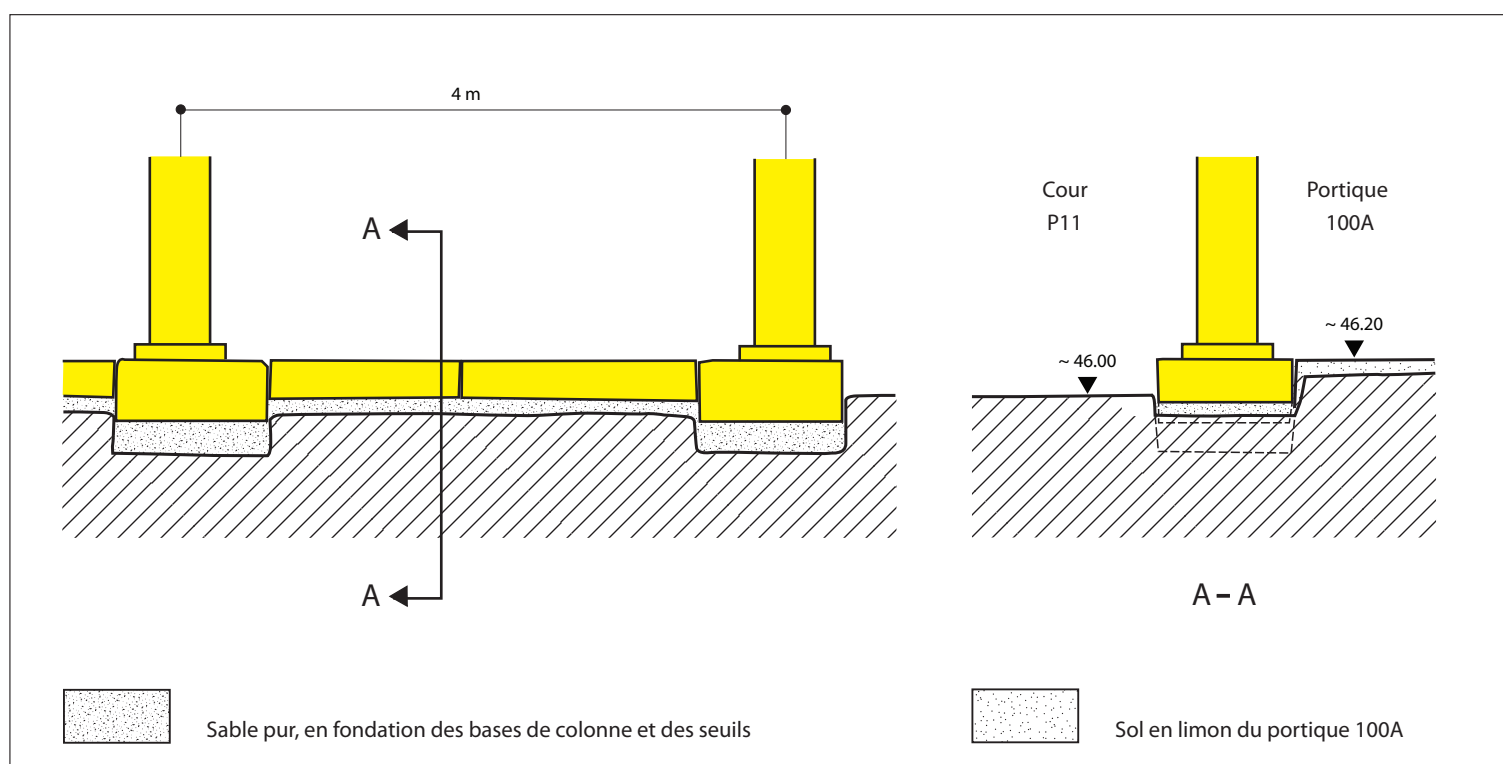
Fondations de la colonnade du portique 100A, coupes restituées
